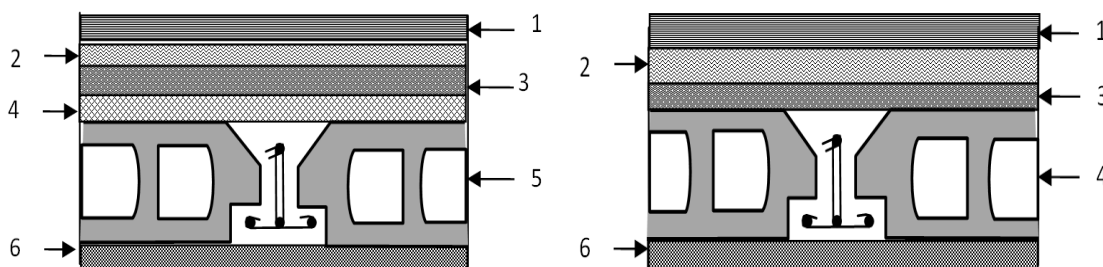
Coupe transversale d'un plancher terrasse inaccessible et étage courant
